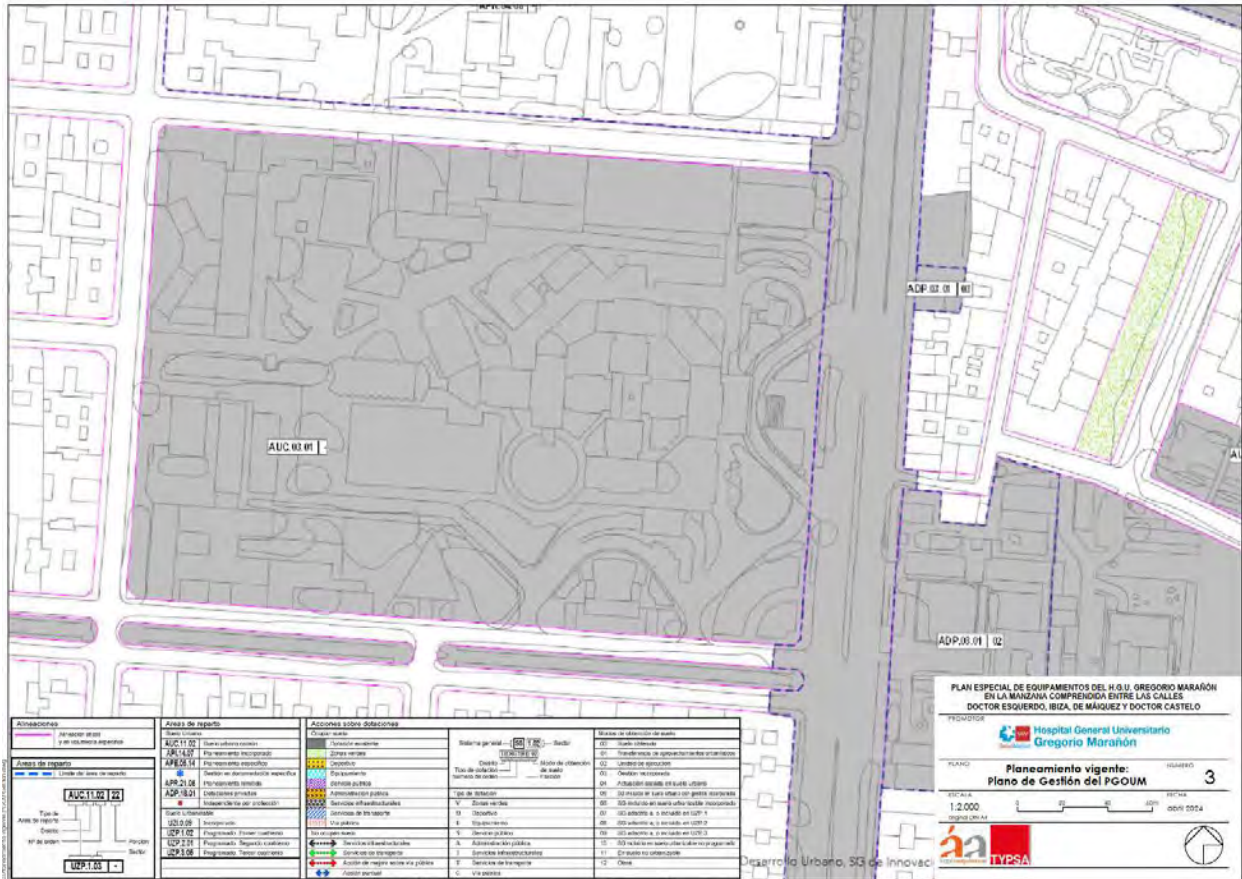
Planeamiento vigente. Plano de Gestión del PGUOM. Hospital situado en dotación existente
